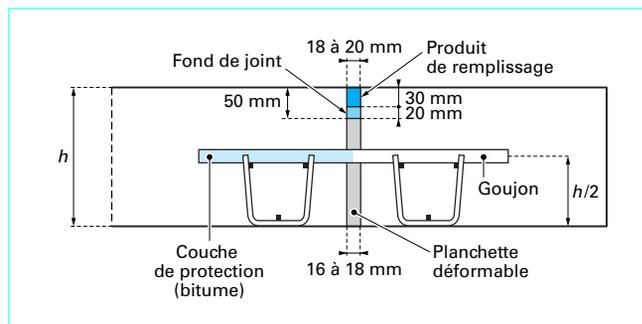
Joint transversal de dilatation de dalles en béton goujonnées (BC_g)
